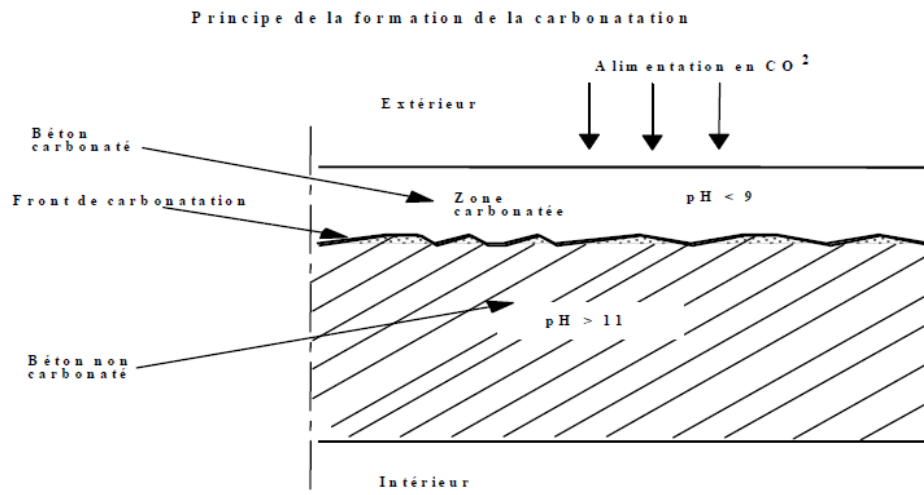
Coupe théorique d'un mur en béton. [33]
